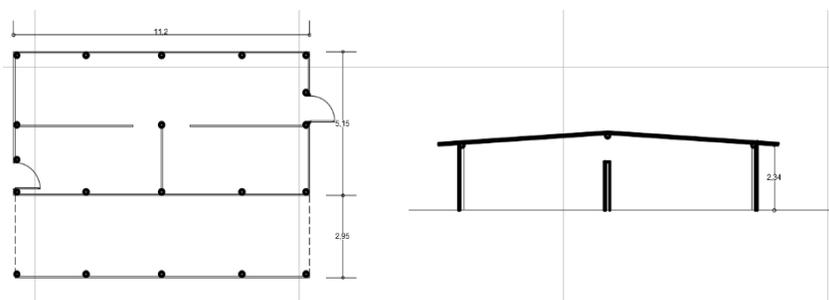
Planta arquitectónica y sección de vivienda de palapa.
